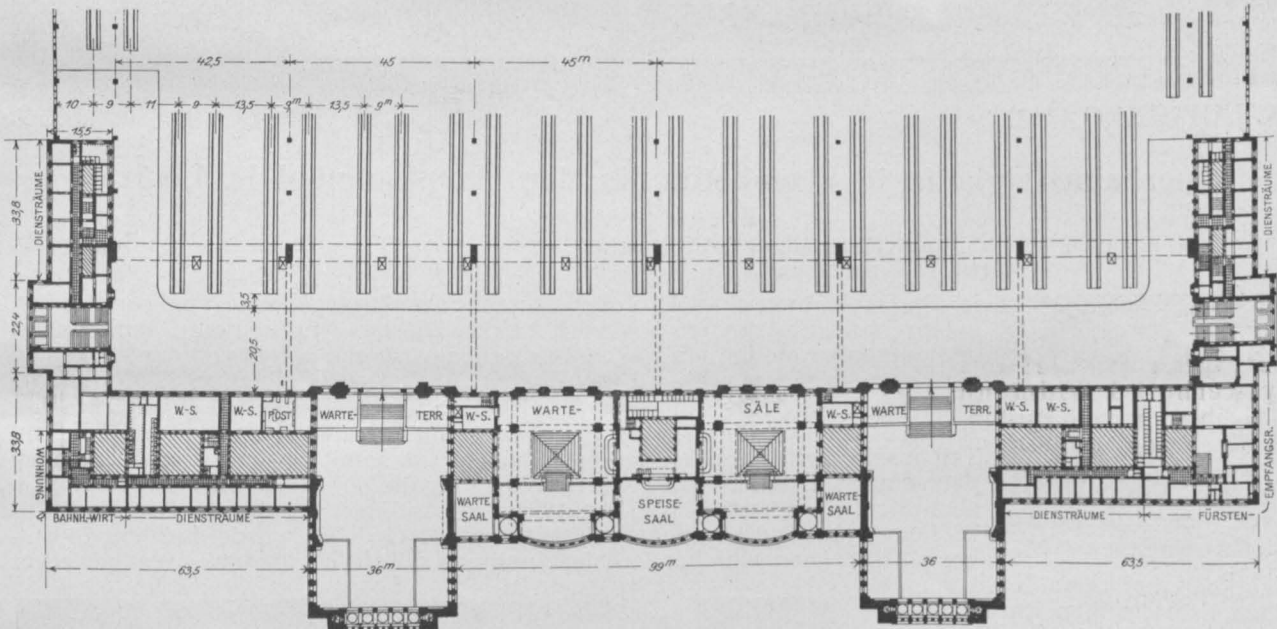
Grundriß des Empfangsgebäudes in Bahnsteighöhe.
